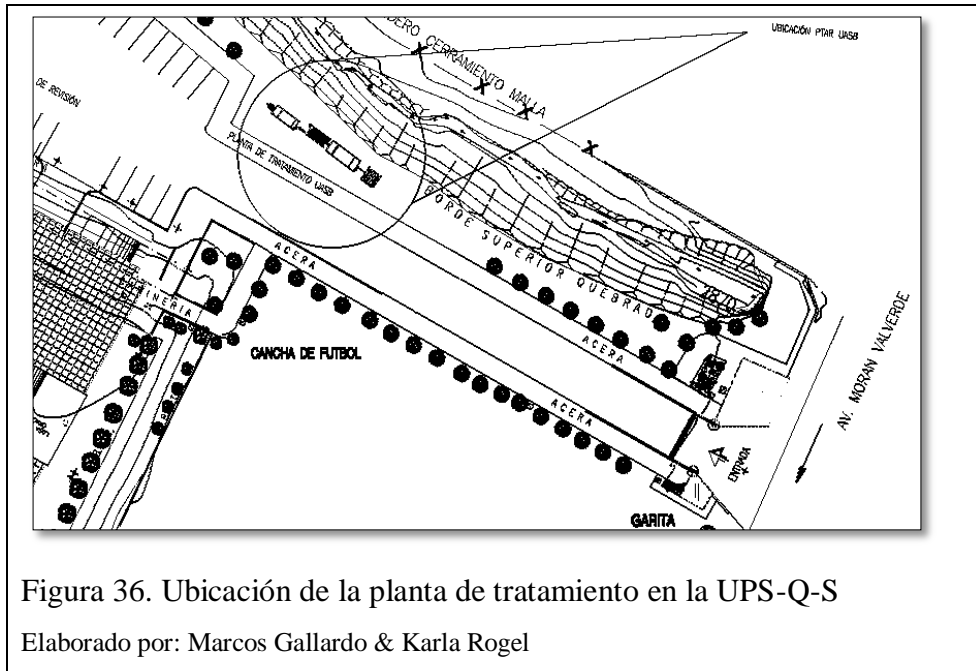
Ubicación de la planta de tratamiento en la UPS-Q-S
